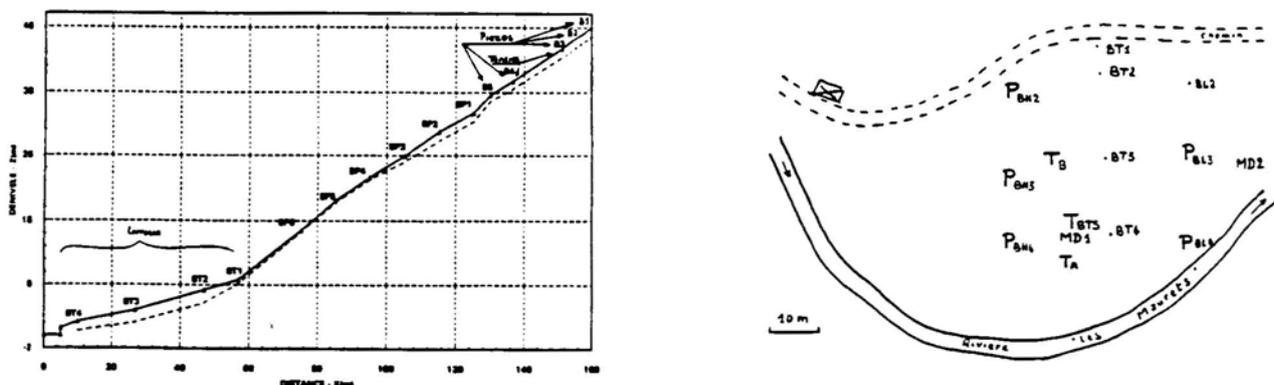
Coupe du versant étudié et vue en plan de la terrasse
